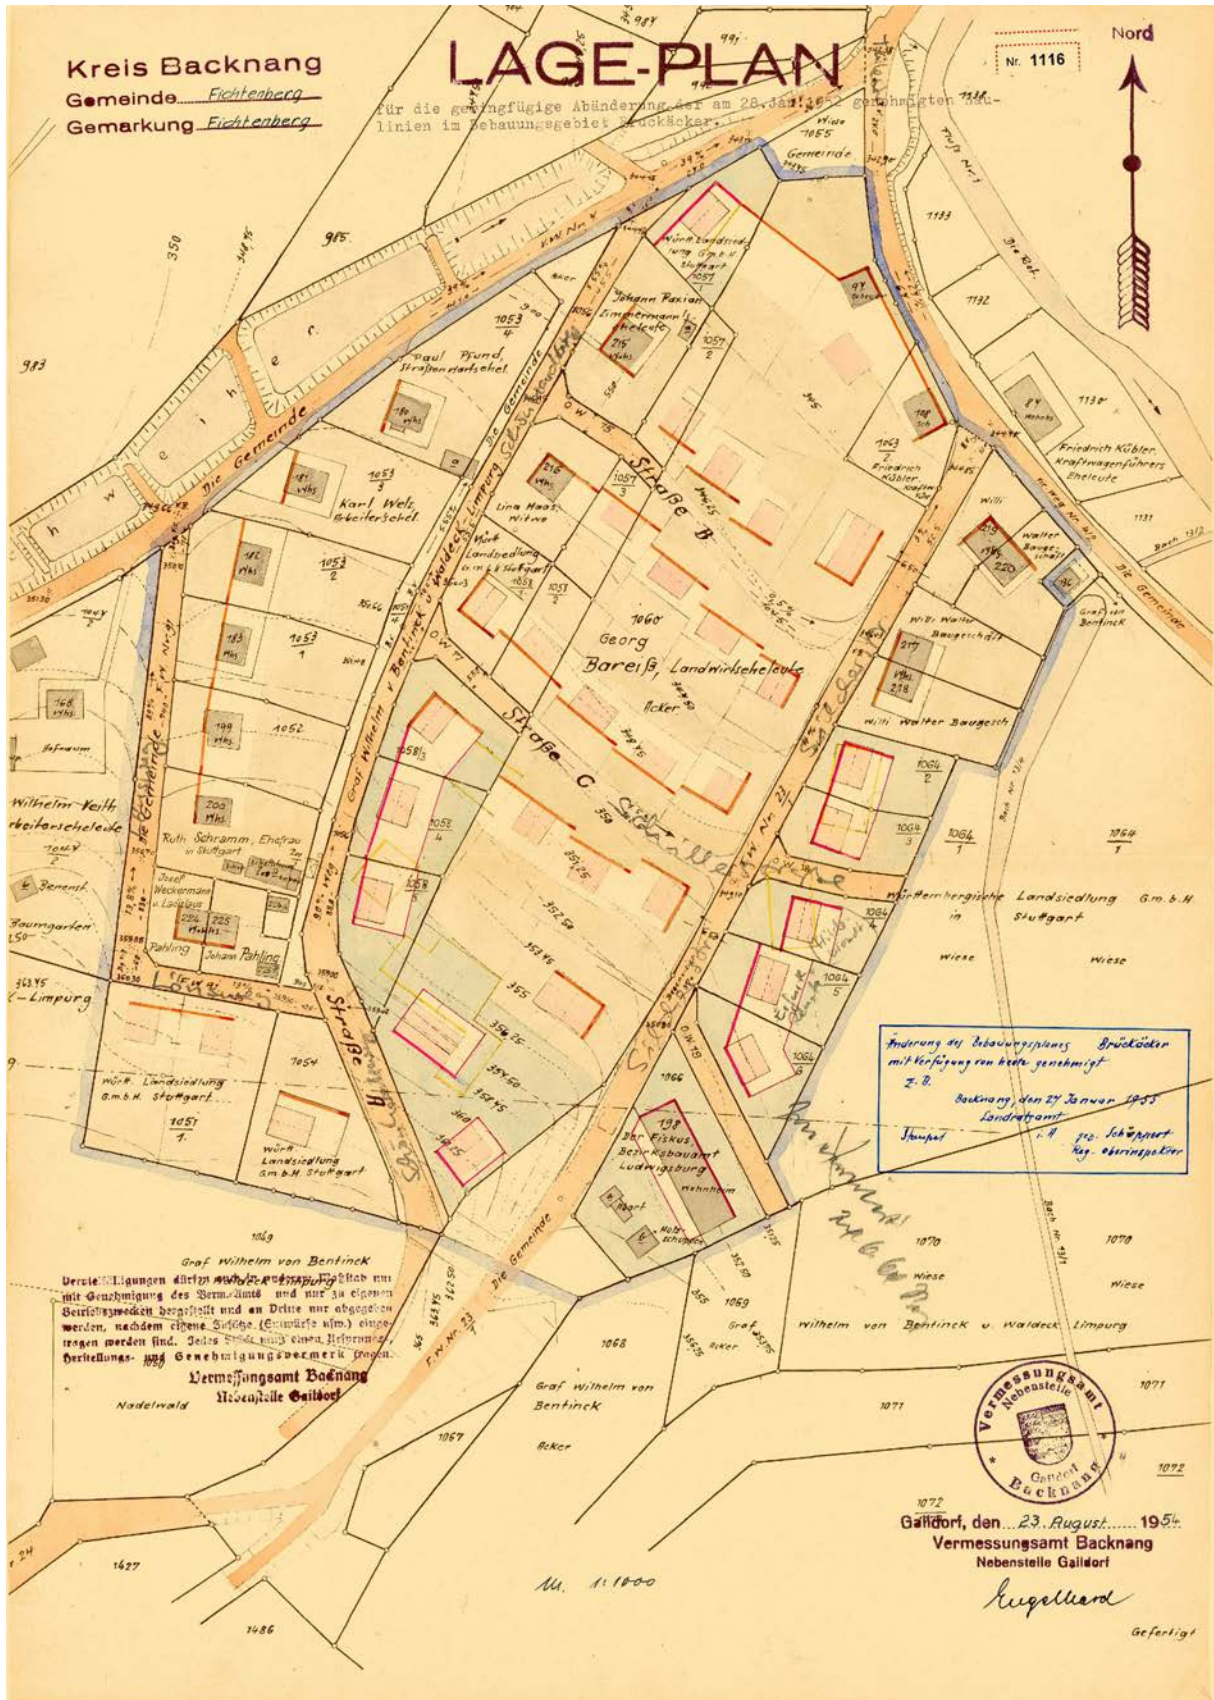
Bebauungsplan „Brückäcker, 1. Änderung“, ohne Maßstab
